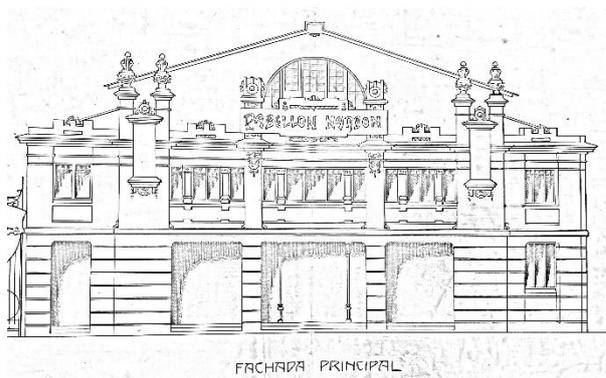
Plano de la fachada reformada del Pabellón Narbón editado por el autor / Archivo Municipal de Santander.
